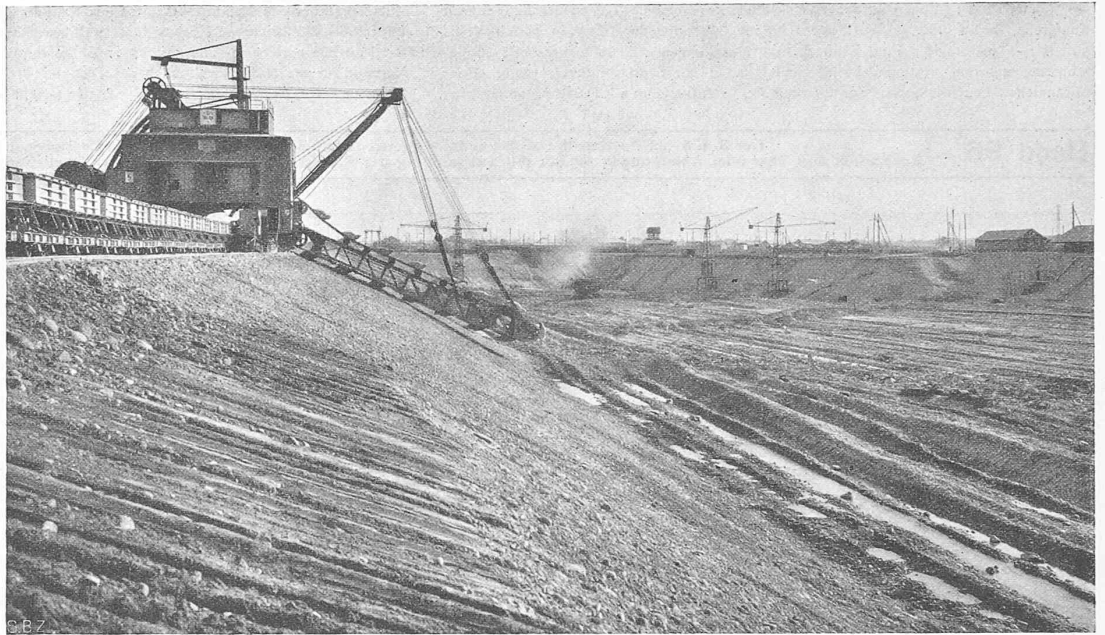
Hochleistungs-Eimerkettenbagger der Lübecker Maschinenbaugesellschaft für den Aushub der Maschinenhausbaugrube.
